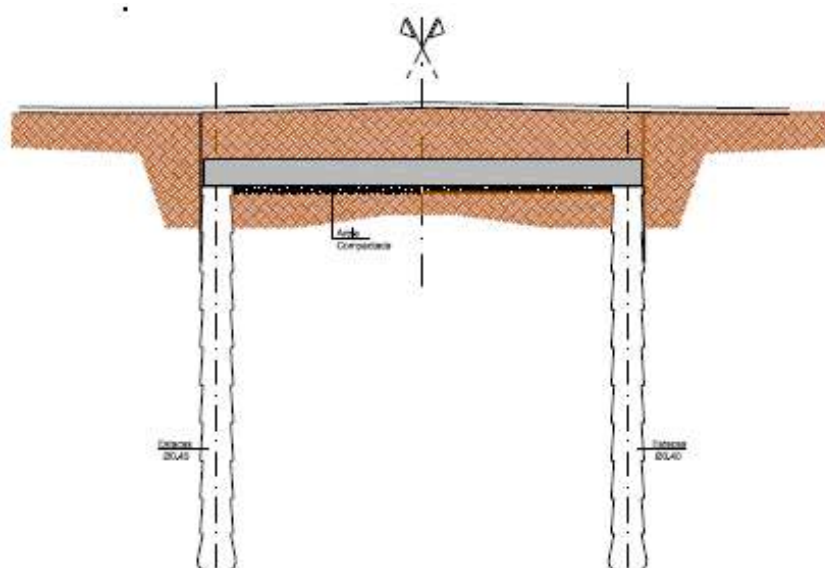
Fase 5 - Aterro sobre a laje de topo e reposição das condições iniciais, incluindo pavimentação
